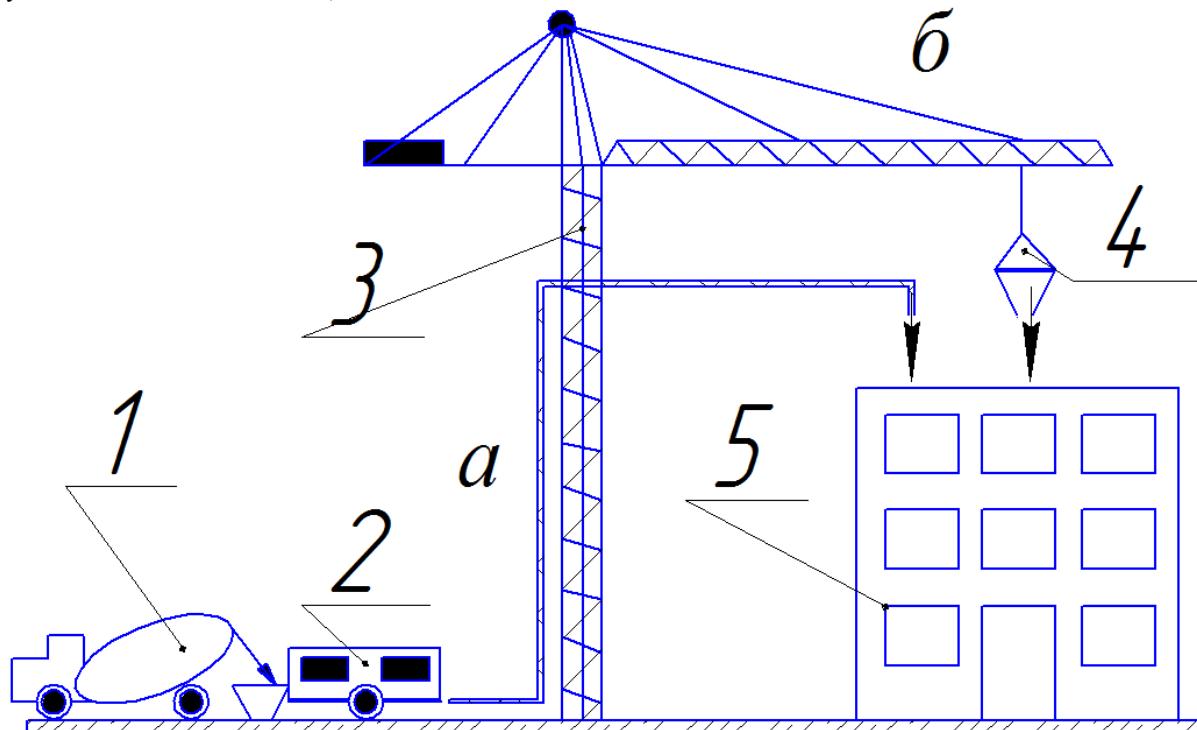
Існуючі технології укладання бетонної суміші при будівництві будівель і споруд: а – бетононасосом; б – краном
